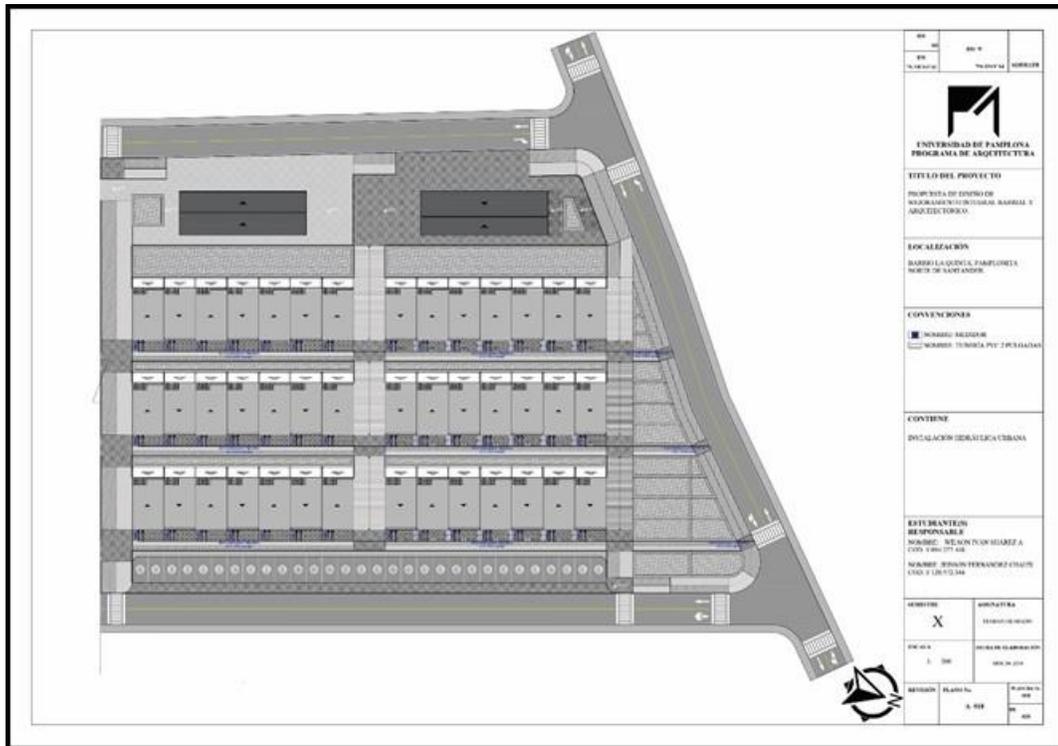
Vivienda Por Reposición 3 Planos 2
